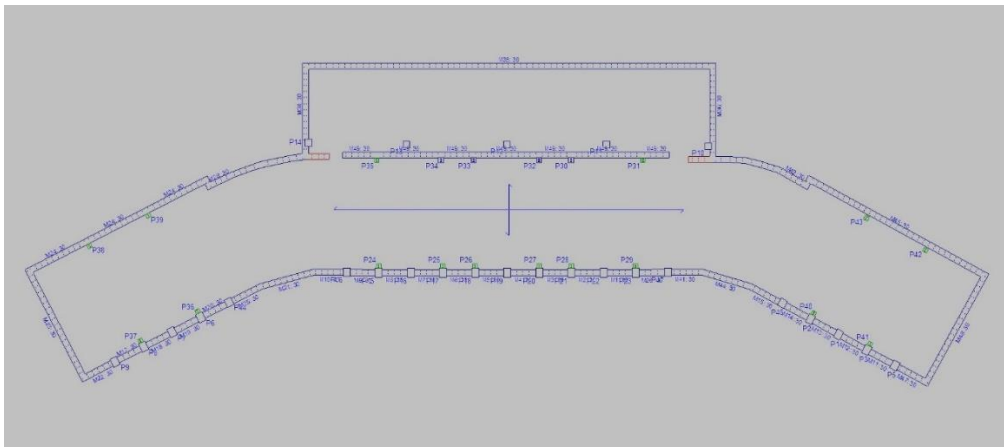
Planta 4 del modelo de 5 plantas simplificado
